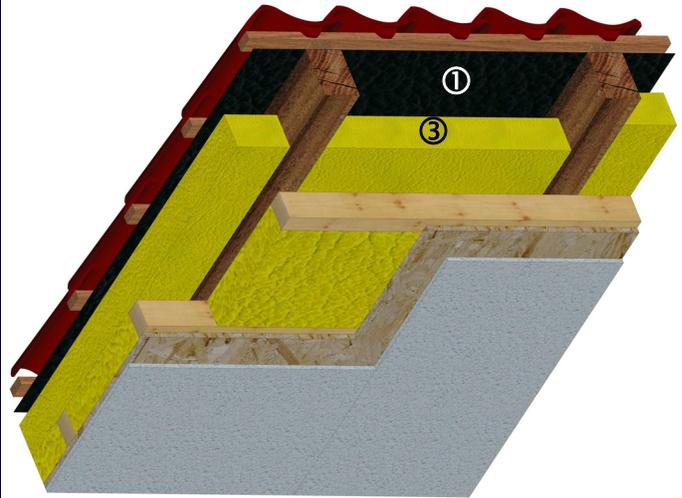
Dachausbau – Aufbau der Konstruktion
